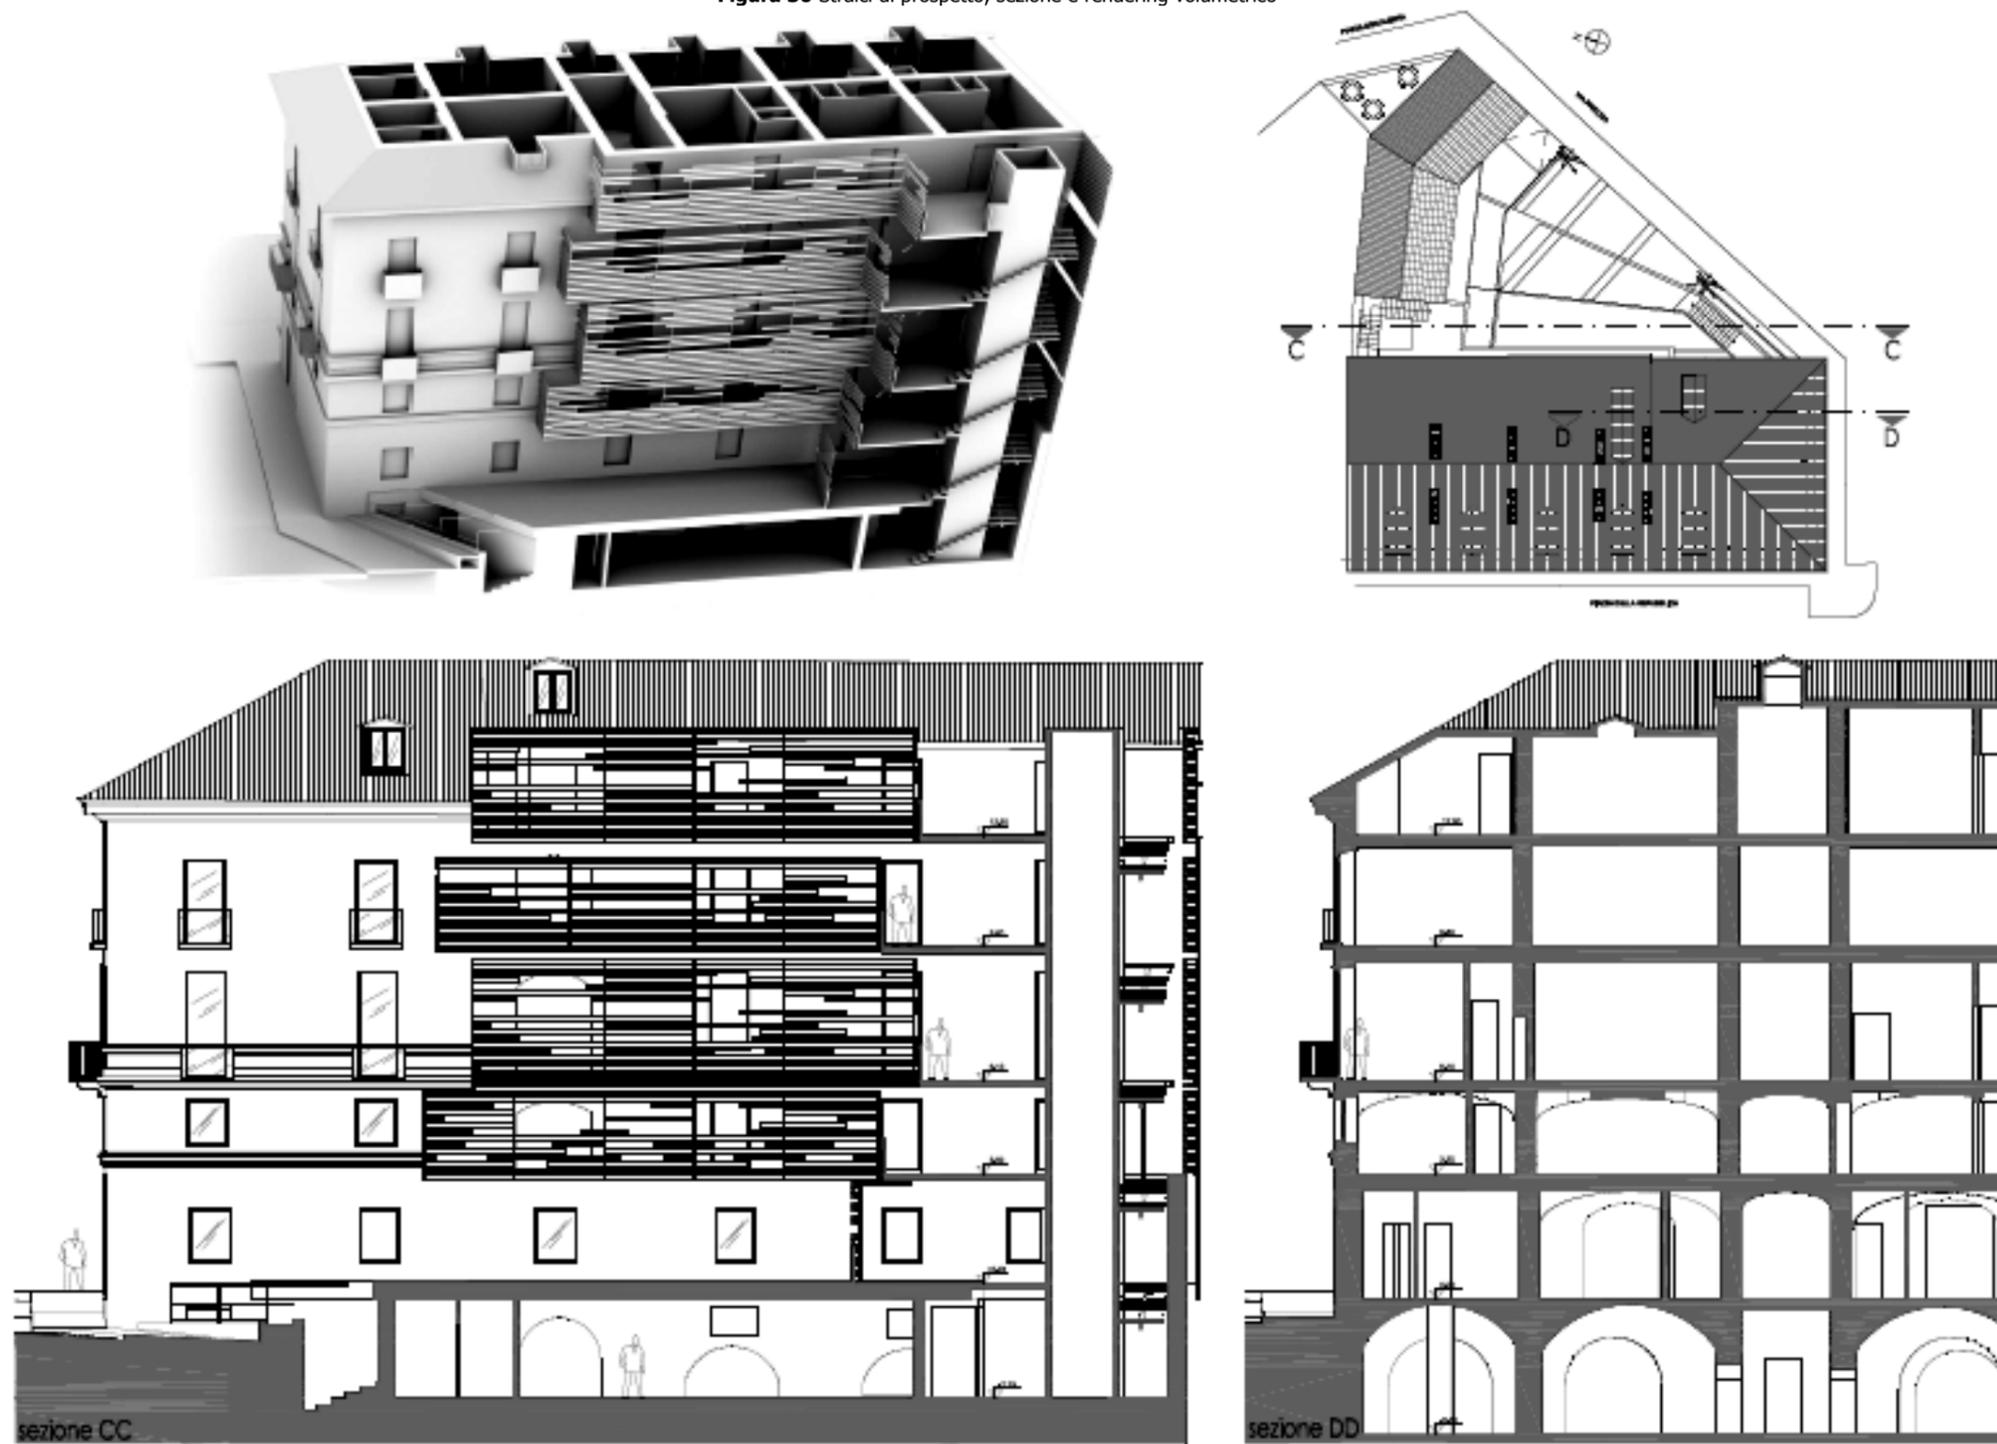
Stralci di prospetto, sezione e rendering volumetrico
